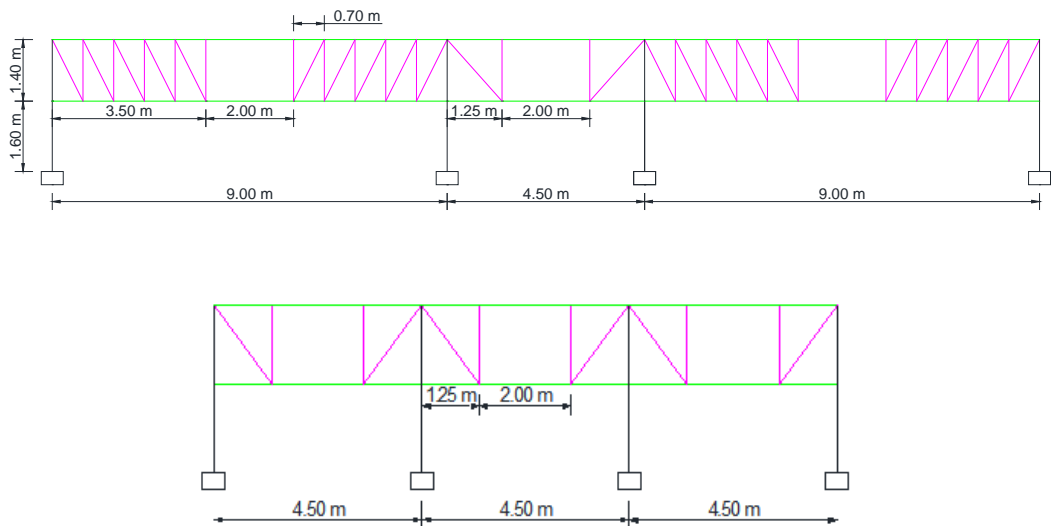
Configuración de los pórticos con viga reticulada y el segmento especial Vierendeel en la dirección Y.
